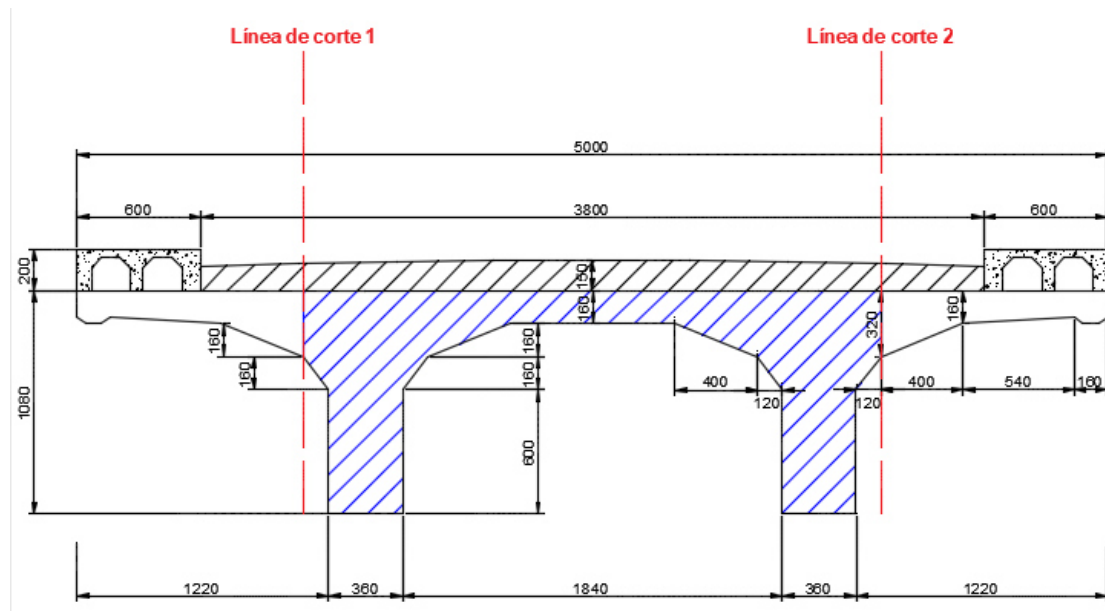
Geometría sección transversal y cortes longitudinales.
